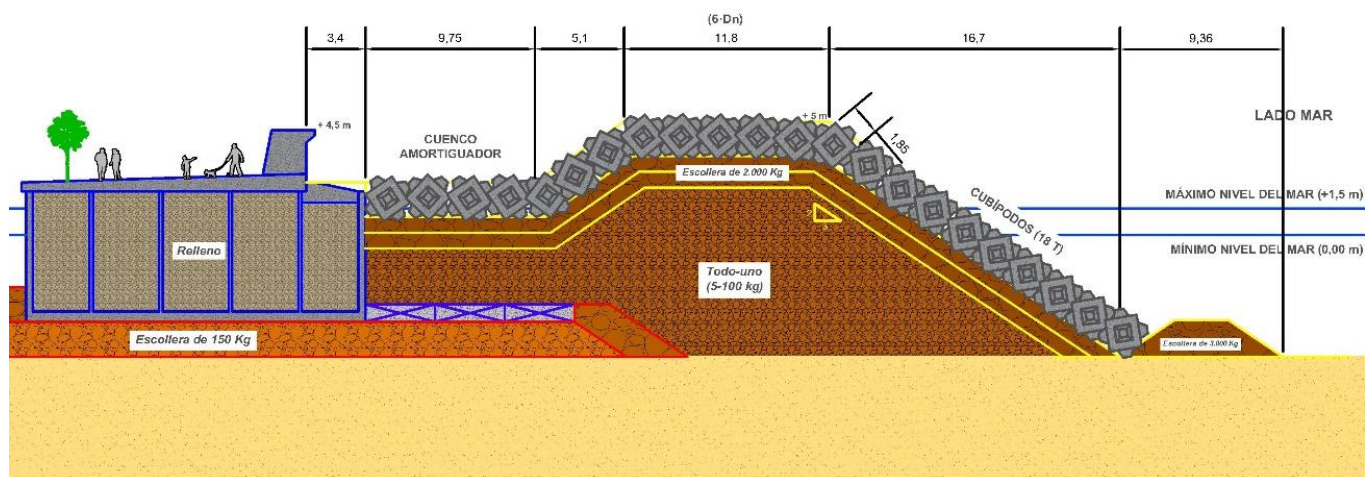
Sección tipo de la Alternativa F. Cotas en m.
